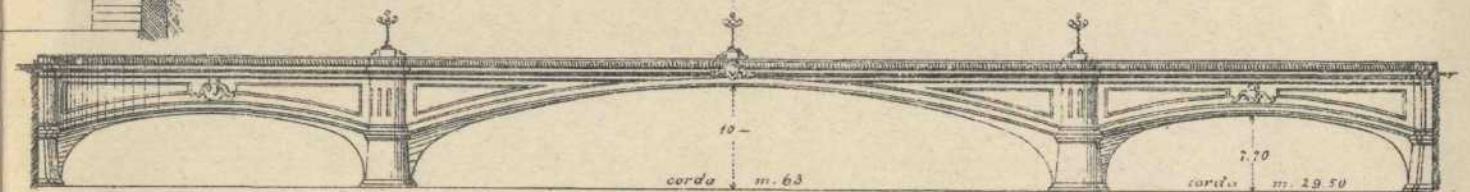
Altro Progetto di ponte in muratura dell'Ing. Ferria.
